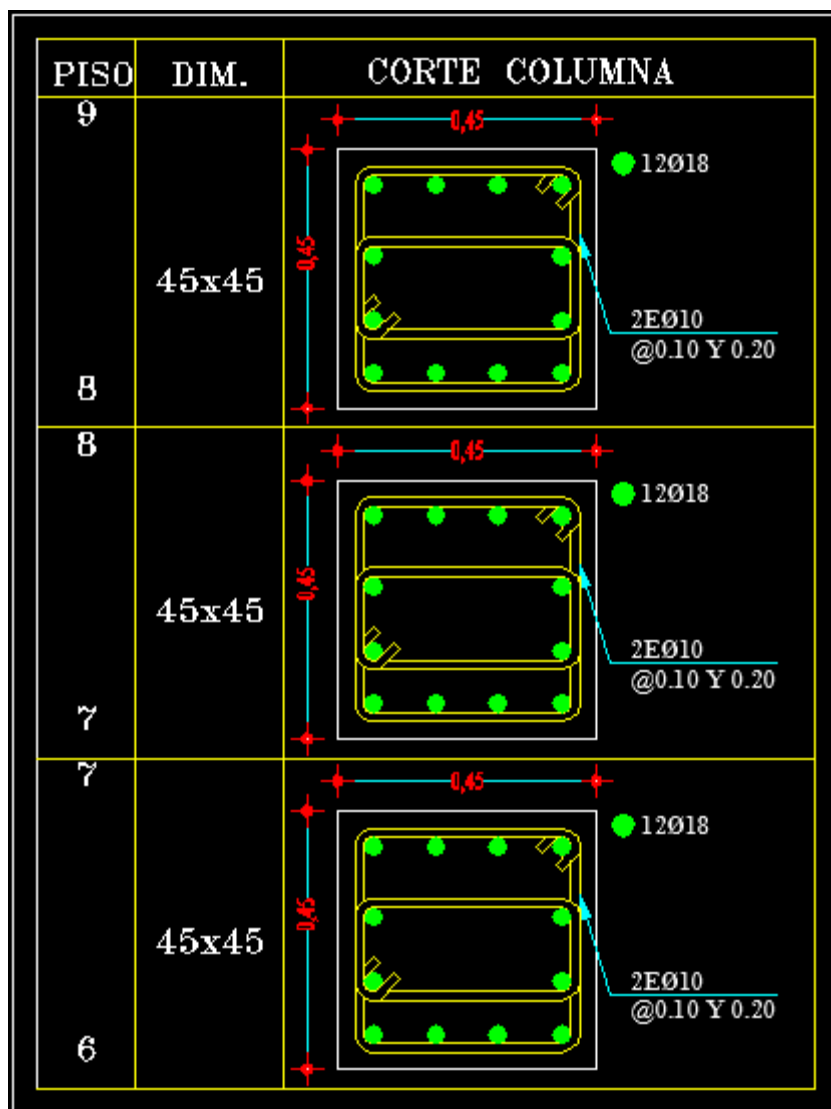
Corte típico de las columnas Edifi. 9 Pisos
